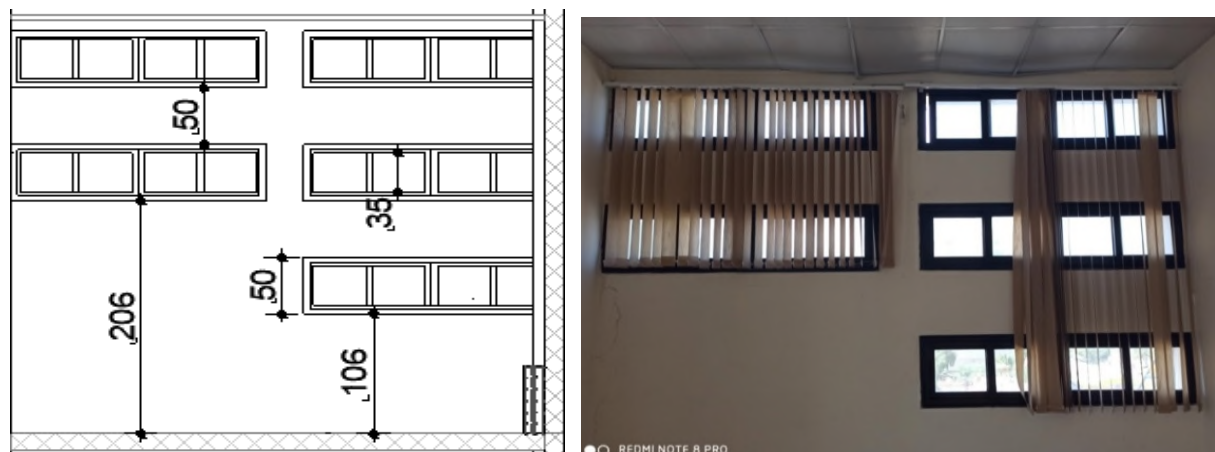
vue et coupe sur les baies vitrées de la façade sud-ouest. (Source : Auteures, 2021).
